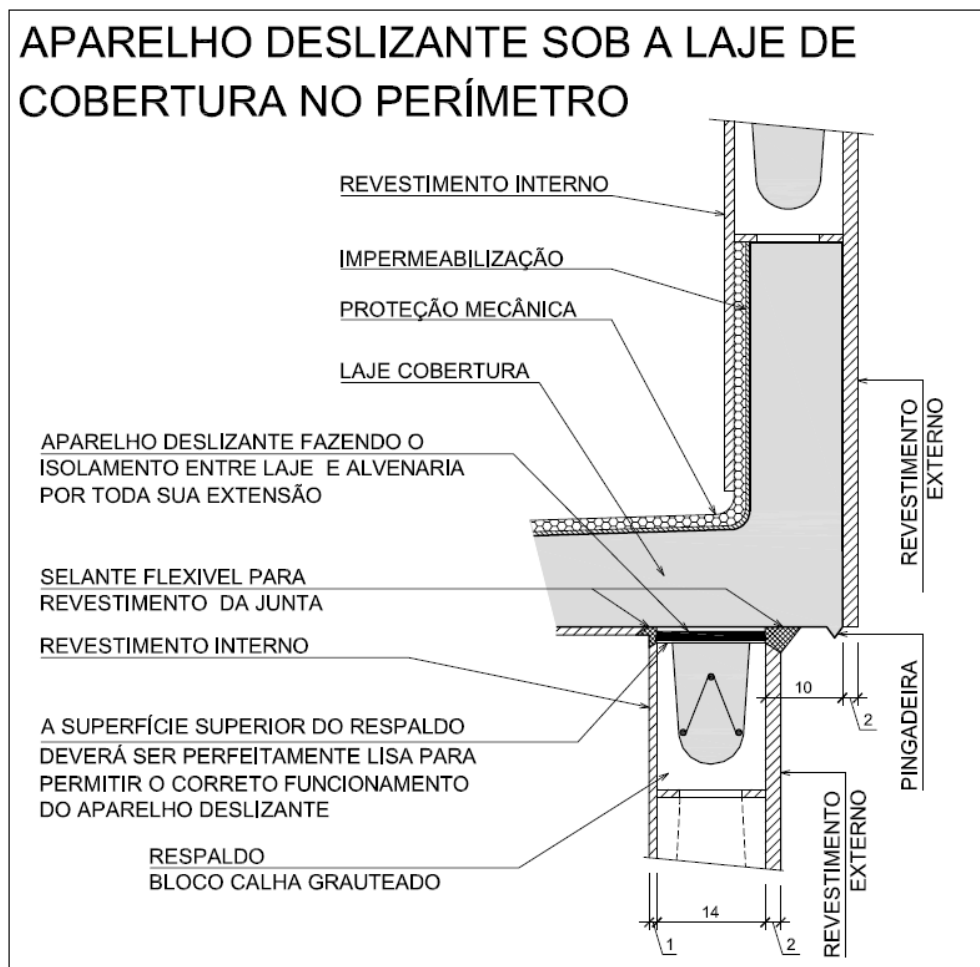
detalhamento do aparelho deslizante entre laje de cobertura e a parede externa da edificação
